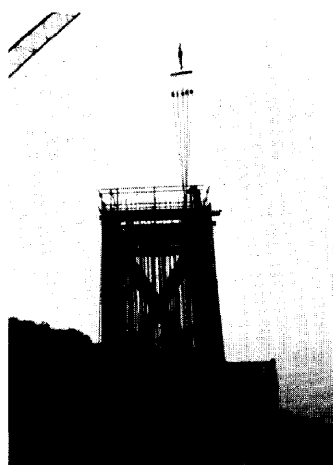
市販クランプによる吊込み。鉄筋下端が鉄骨に当たるとクランプが外れることがある。
